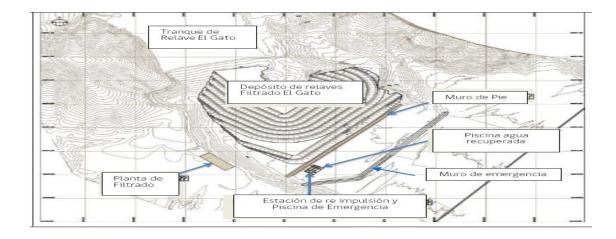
Terrazas la planta. Fuente: Atacama Kozan.
